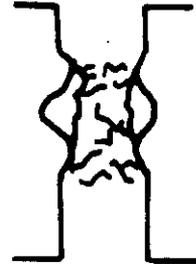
Desprendimiento del concreto y pandeo de barras en columnas
